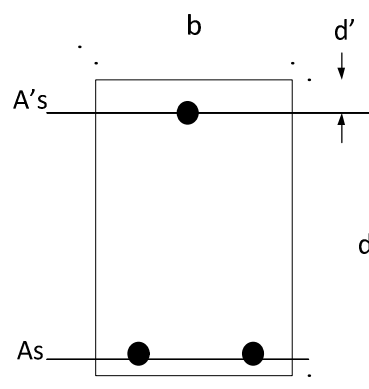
Viga rectangular doblemente reforzada. (Elaborado por la autora)
